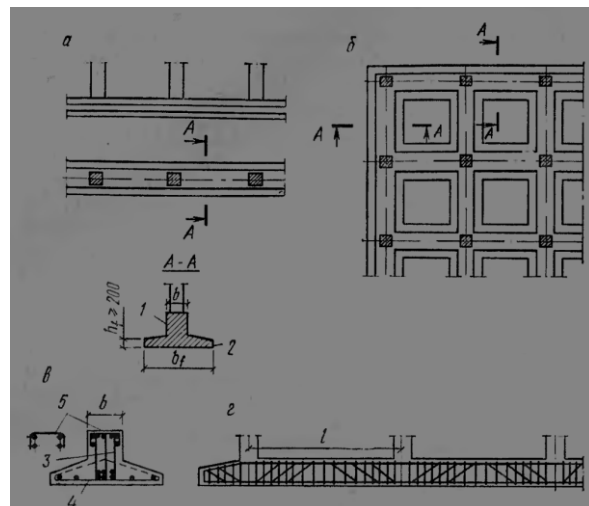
Ленточные монолитные фундаменты под колоннами
